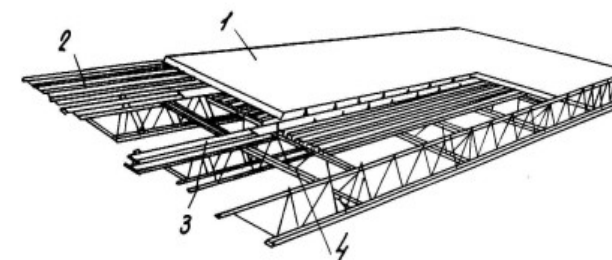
Перекрытие, выполненное по 2-й конструктивной схеме
